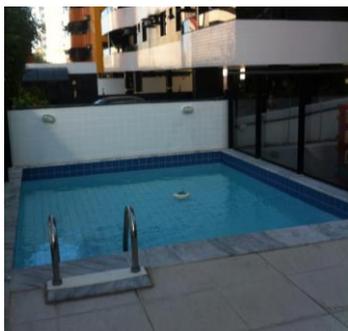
Piscina adulto executada – Spazio Vitale
